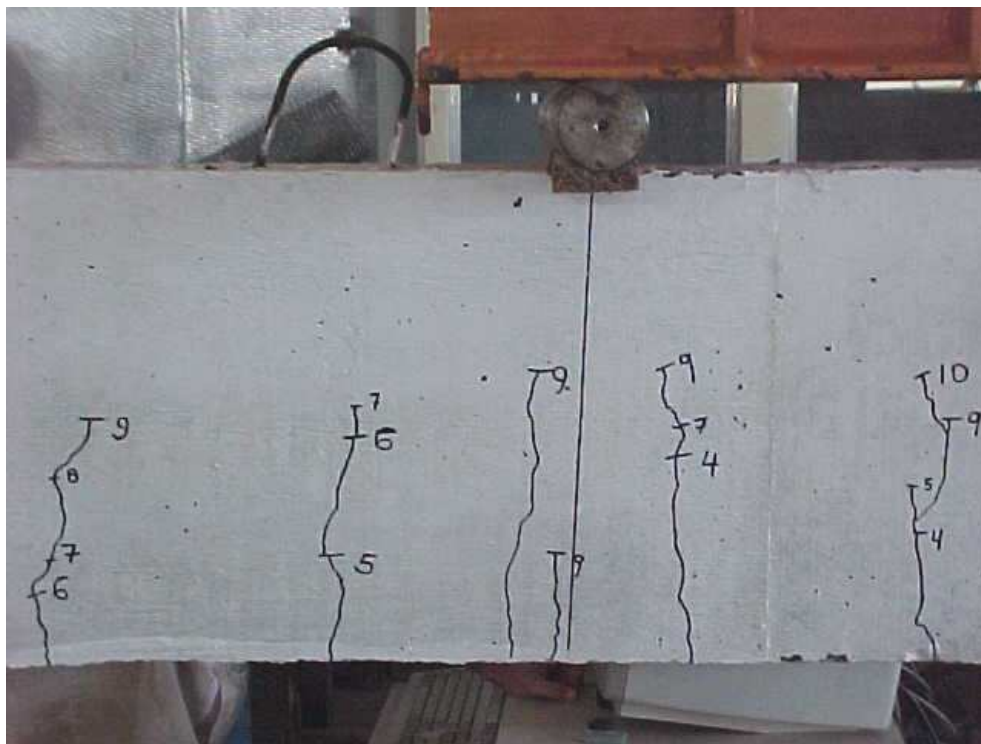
Detalhe do ponto de aplicação de carga na região central da viga
